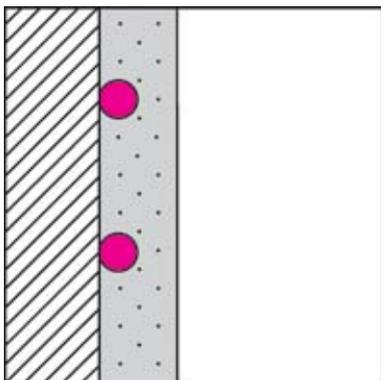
TW1 – Rohrsystem in Unterkonstruktion mit Trockenausbauplatte
